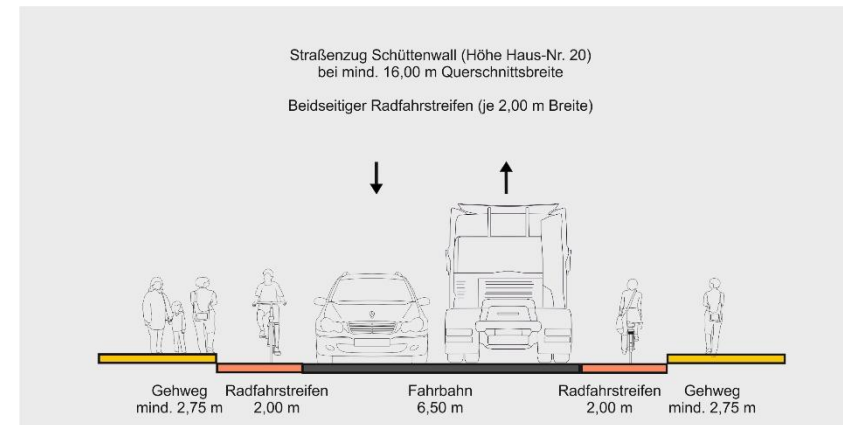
Straßenquerschnitt Schüttenwall Variante A mit Radfahrstreifen
